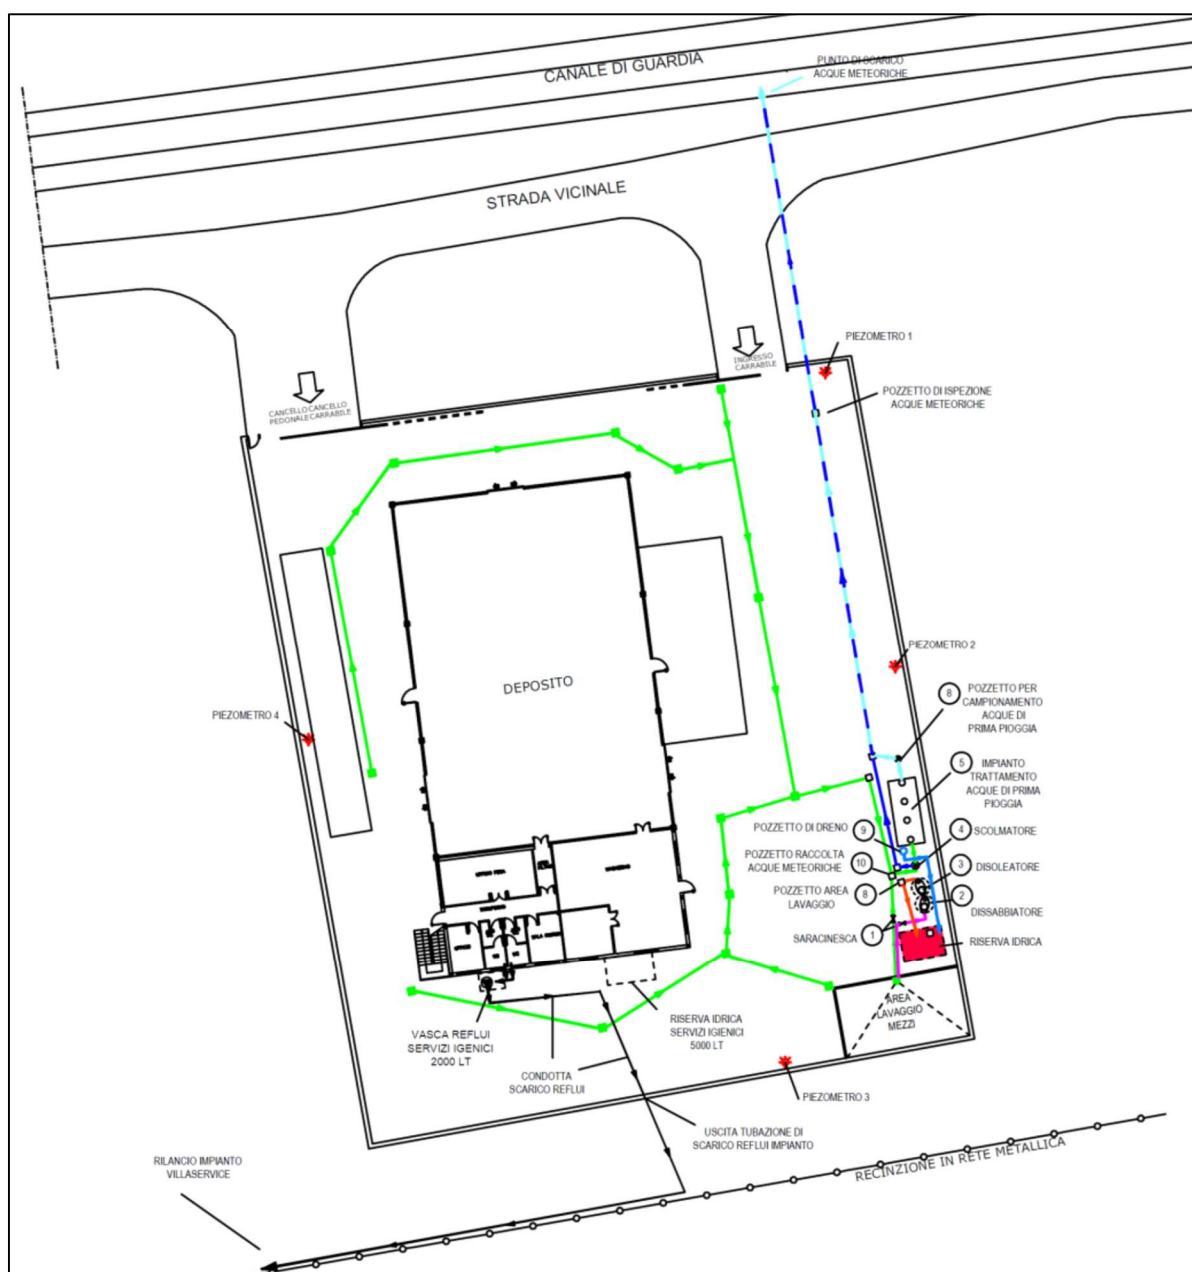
/I: Planimetria delle reti e degli impianti di gestione acque e reflui stato attuale
